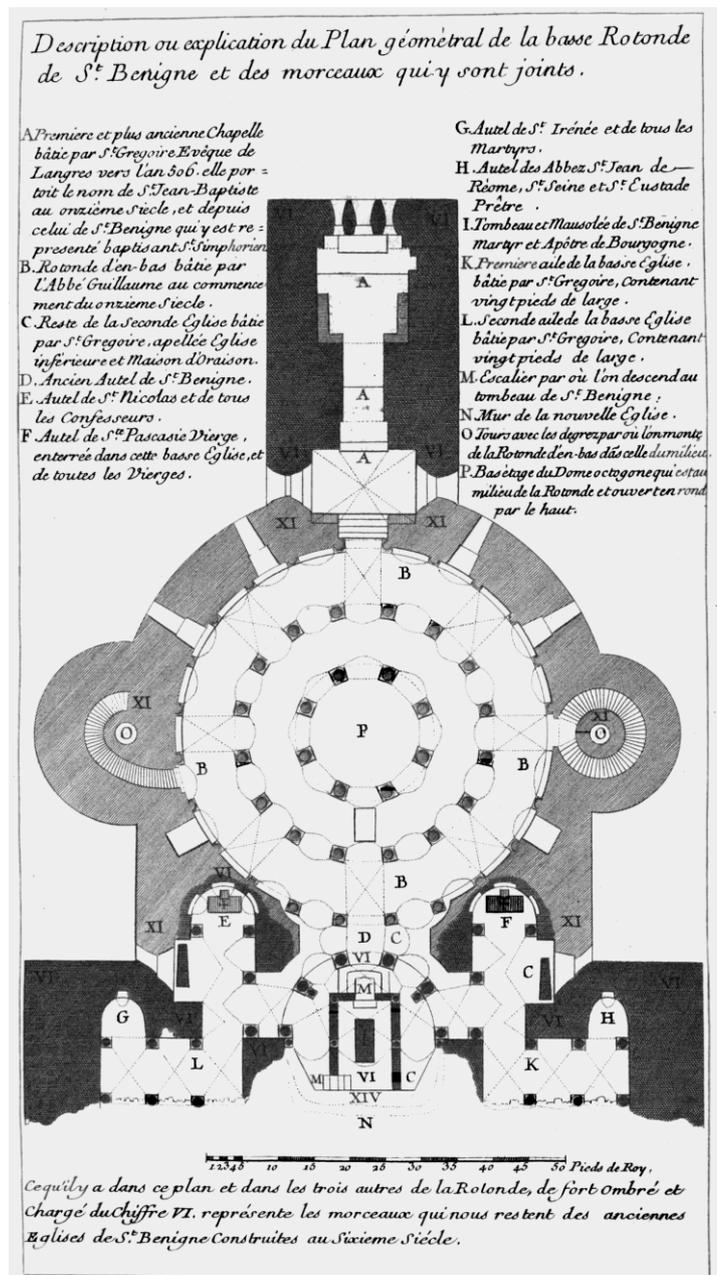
Grundriss des Rotundenuntergeschosses (Dom PLANCHER 1739)
